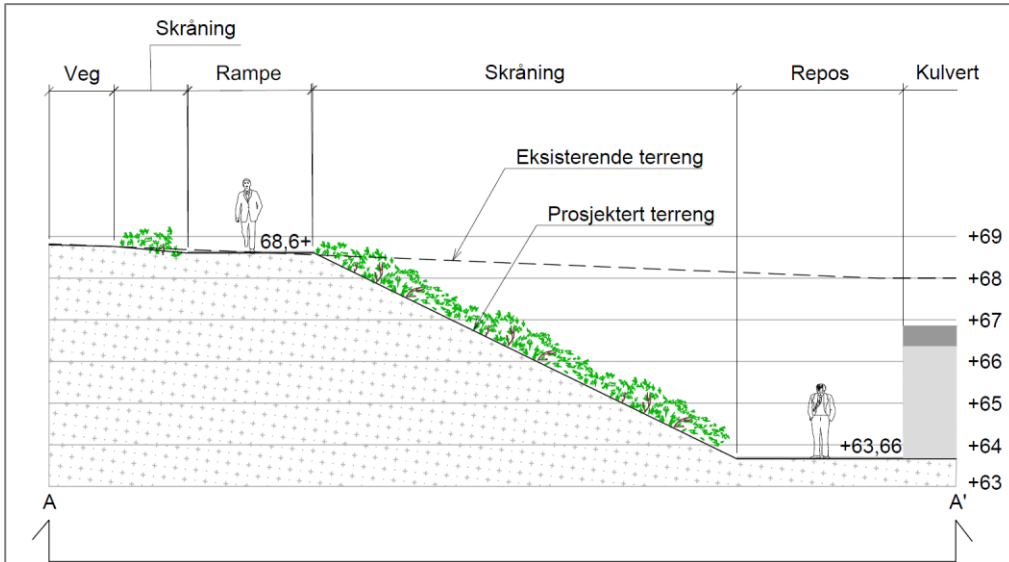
Skisse som viser adkomst fra Øvregata til planskilt kryssing ved Vikersund stasjon.
